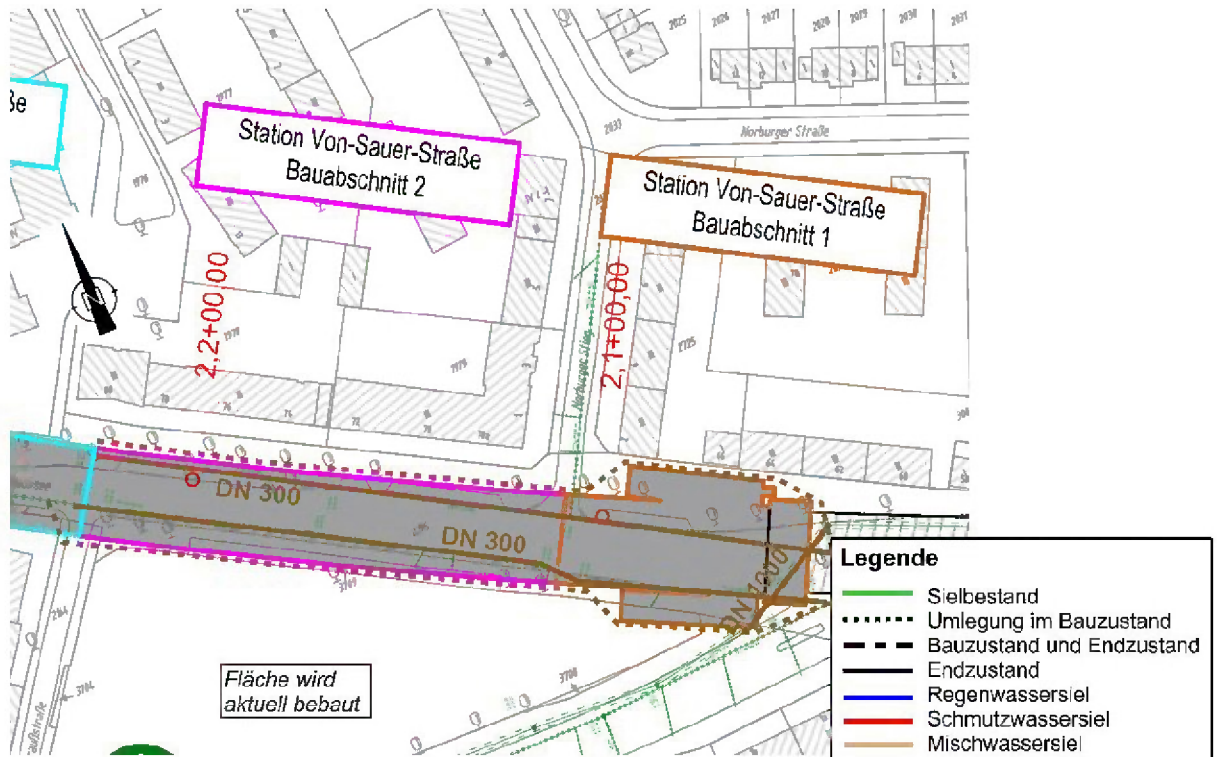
Sielplan Baubereich Station Von-Sauer-Straße (I), Bauabschnitte 1 und 2 (Stand 04.2019)
